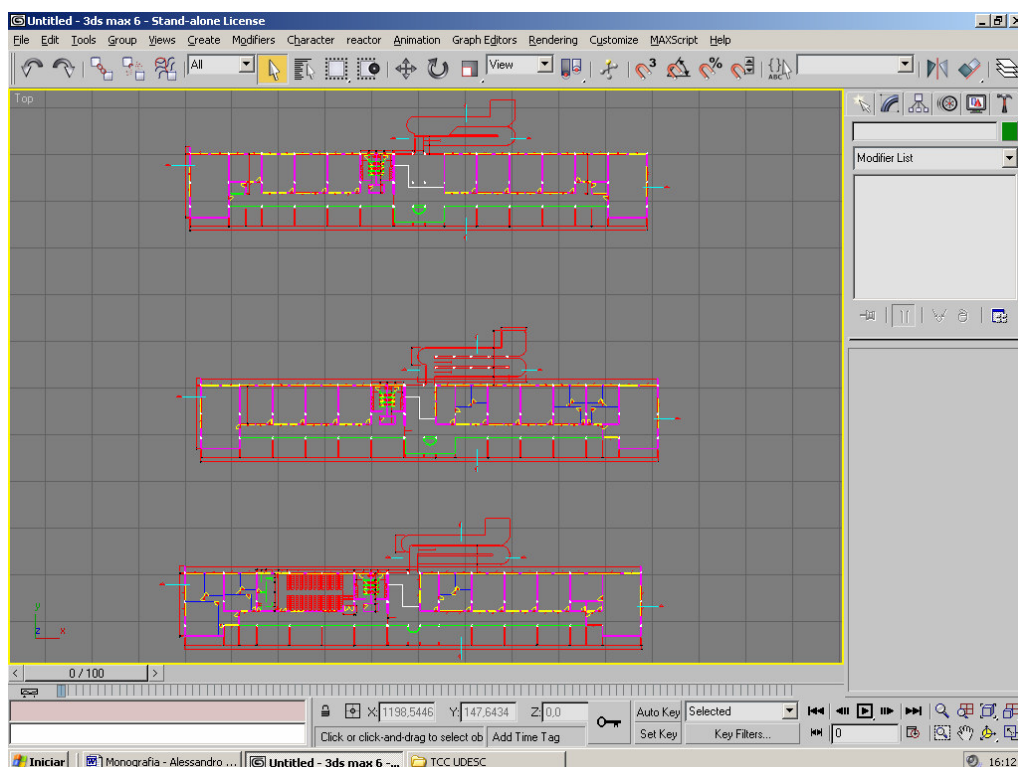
Planta baixa importada no 3DS MAX 6.
